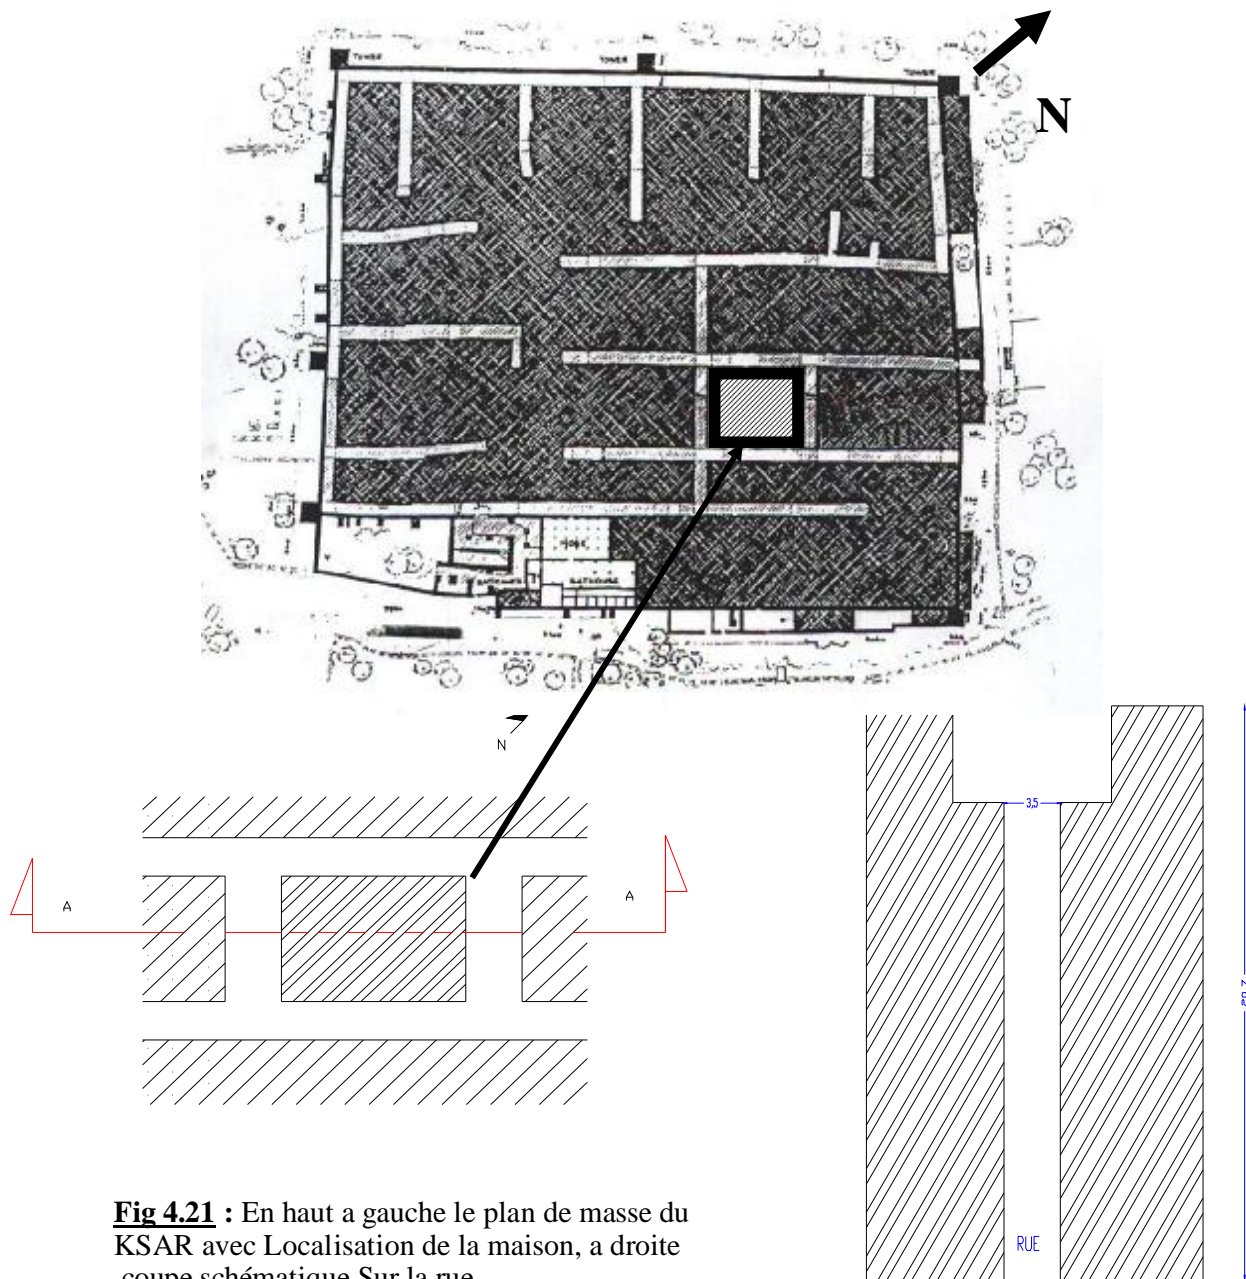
En haut a gauche le plan de masse du KSAR avec Localisation de la maison, a droite coupe schématique Sur la rue.
